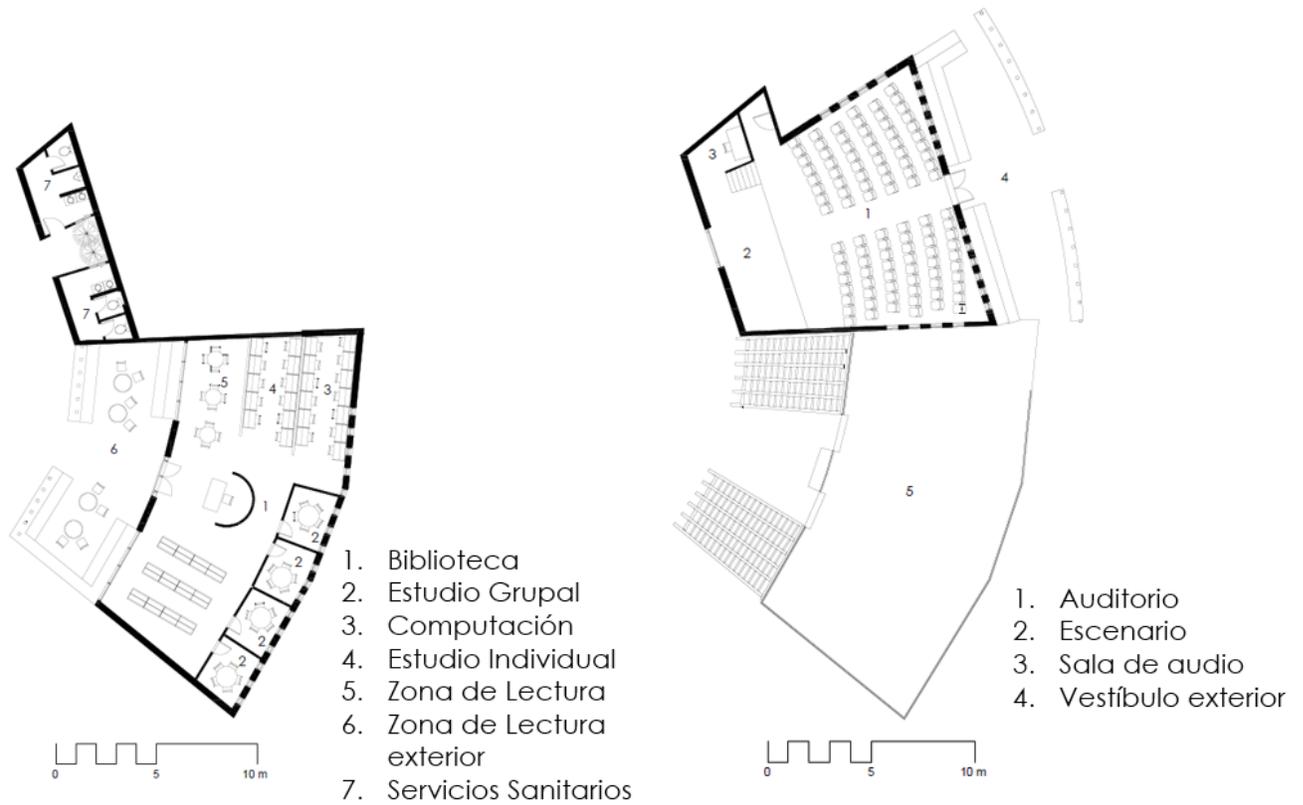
Planta Arquitectónica Nivel 1 Biblioteca
